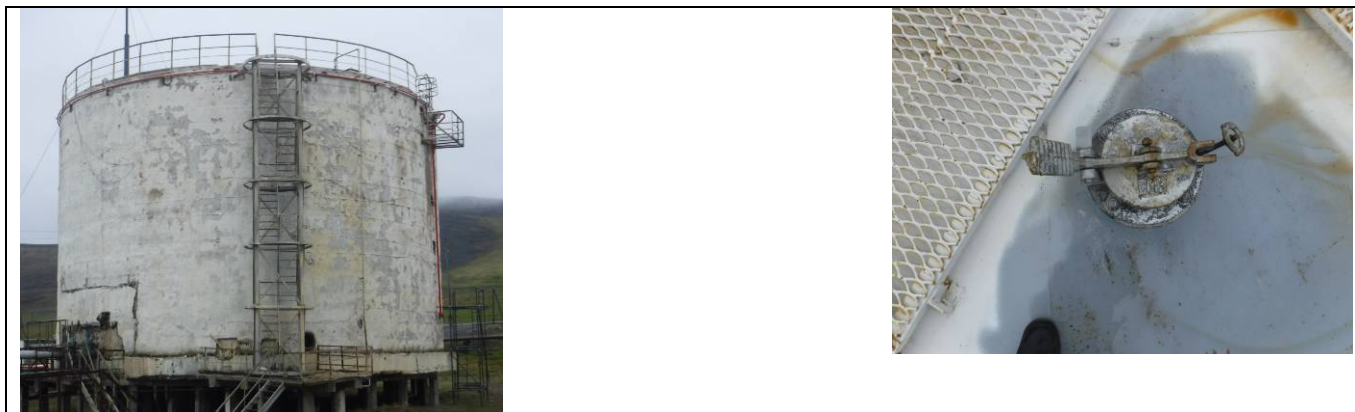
Общий вид резервуара РВС-3000 (№52) с замерным люком
